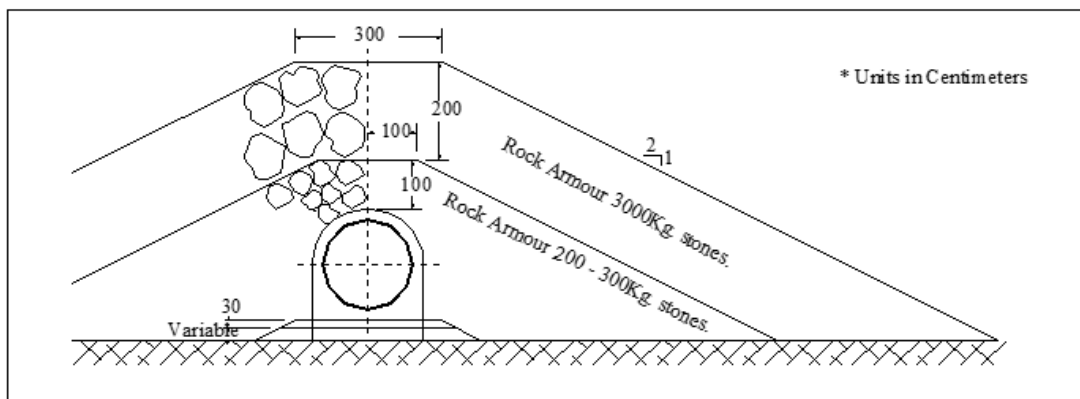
Perfil transversal de uma solução de proteção estrutural. Vala escava sobre fundo rochoso com preenchimento de betão. *Alvarez et al., 2002
